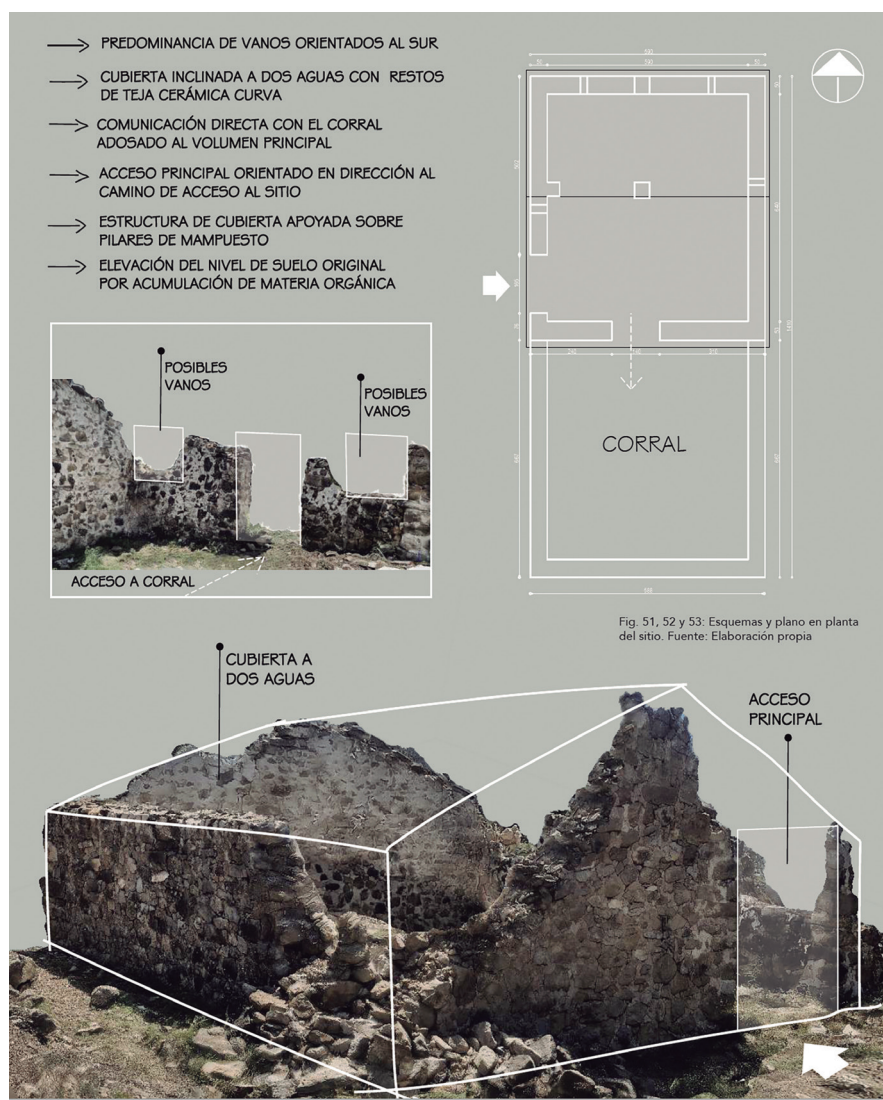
, 52 y 53. Esquemas y plano en planta del sitio. Fuente: Elaboración propia
